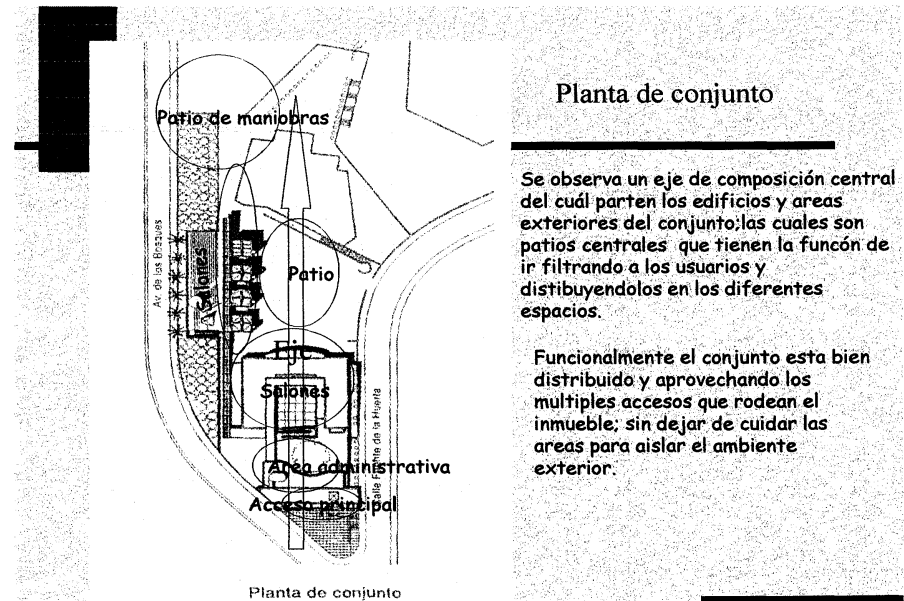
La planta de conjunto y sus diversas áreas del conjunto.
